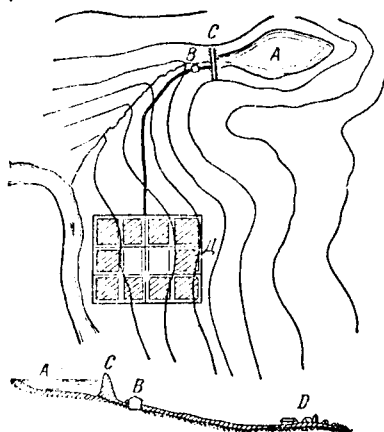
Схема самотечного водопровода из водохранилища: А — пруд, С — плотина, В — отстойник, ВД — трубопровод, Д — поселок.
